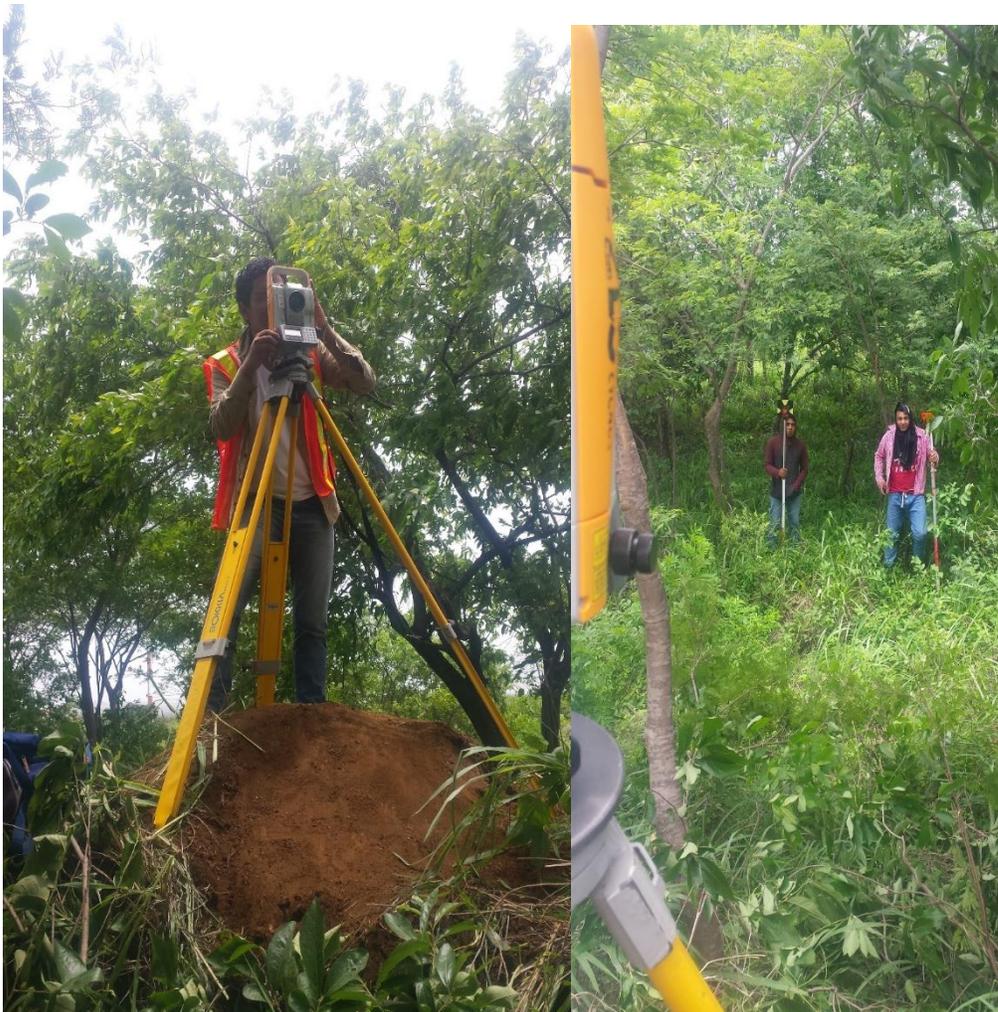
Levantamiento de detalles de las 2.923 Manzanas (2019). Fuente propia
